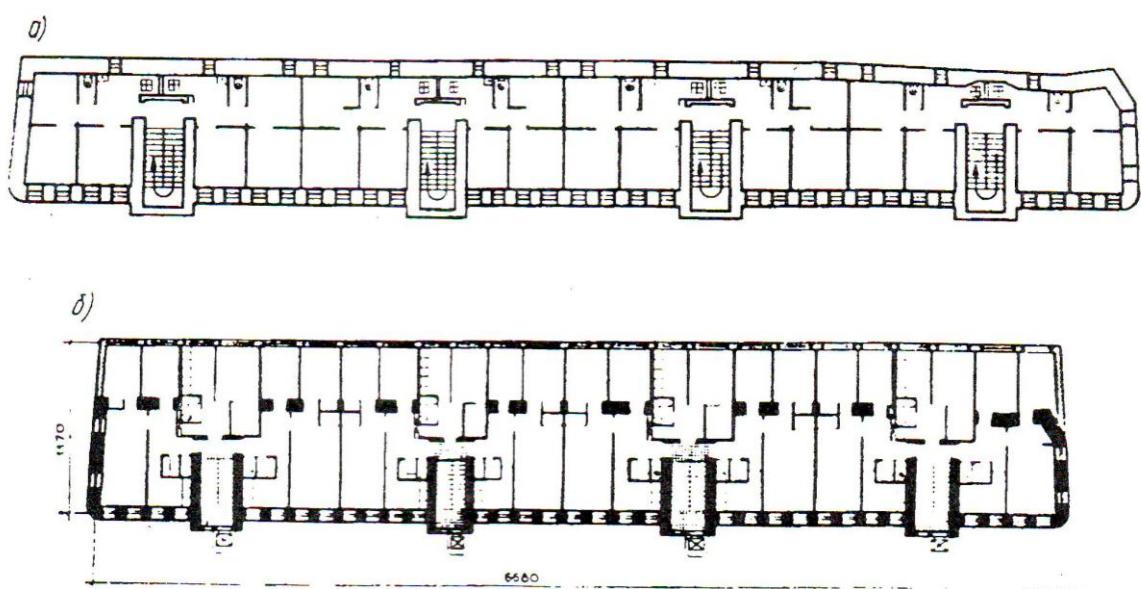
Пристройка параллельного объема в секциях в поперечных лестницах: А – до реконструкции; б – после реконструкции
